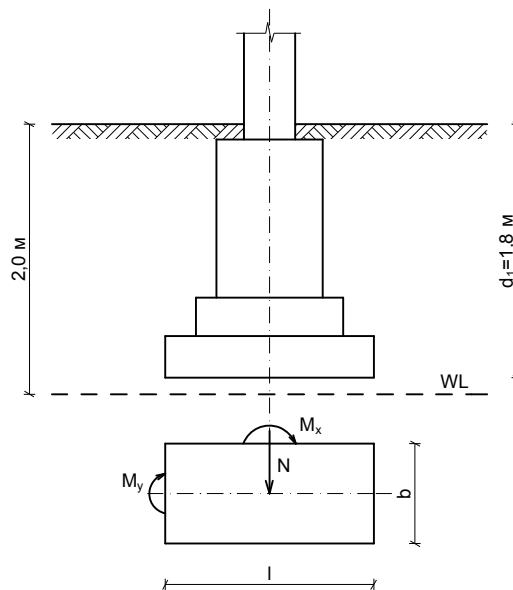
Схема розташування фундаменту у ґрунті і навантажень на фундамент
